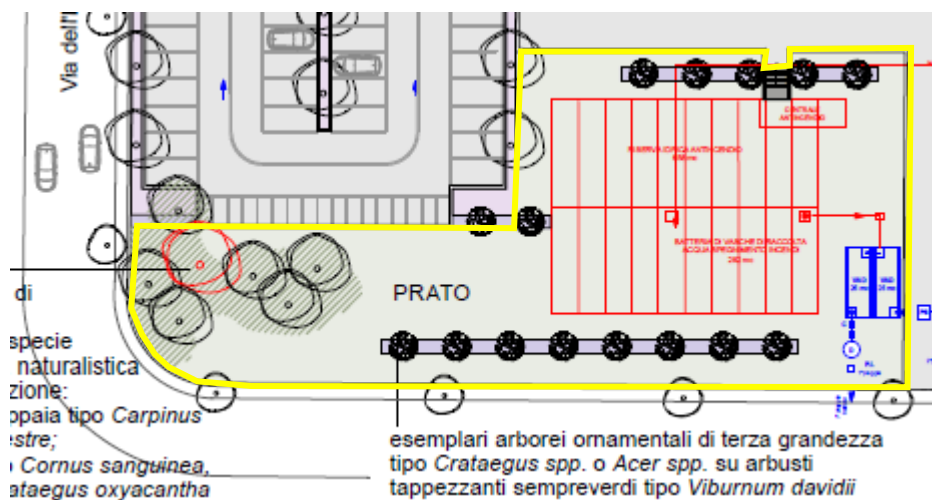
Estratto planimetrico progetto del verde – Stralcio 2 evidenziato in giallo.
